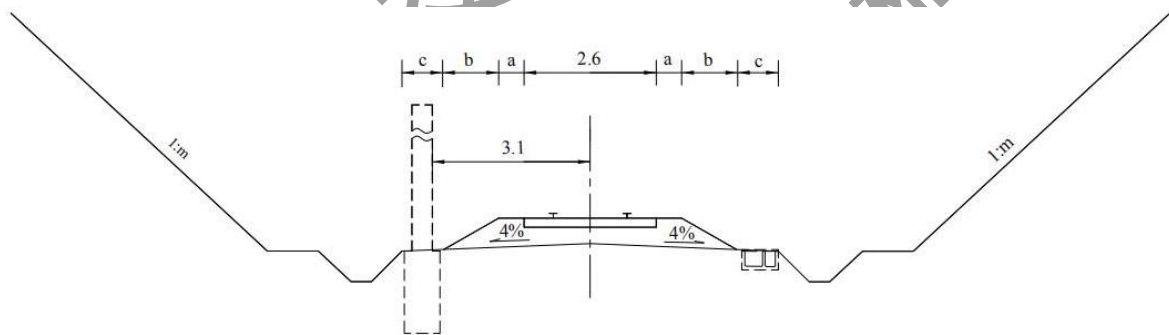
有砟轨道单线硬质岩路堑横断面图 (单位: m)
